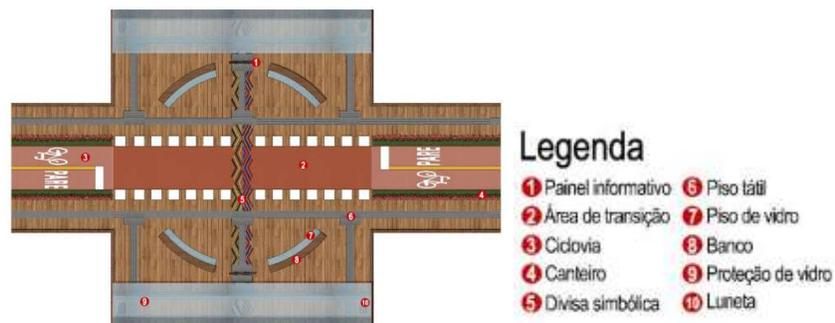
Planta baixa esquemática com a organização dos usos do mirante.
